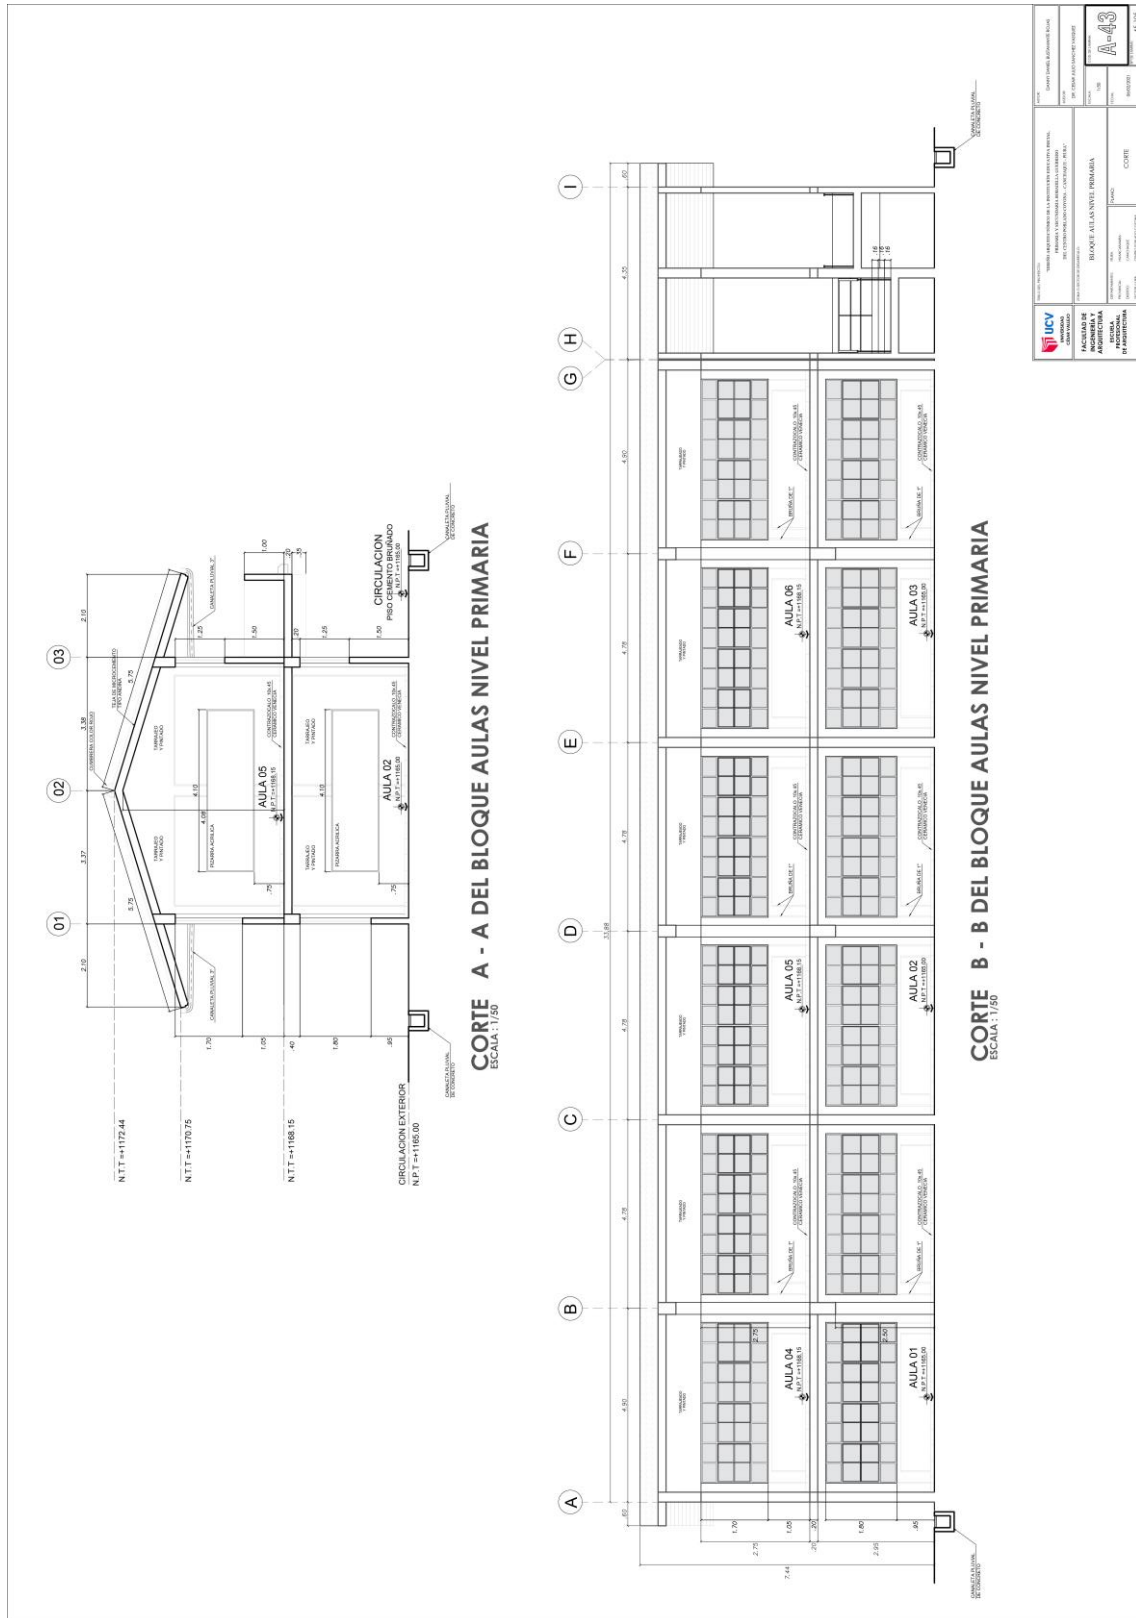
PLANO CORTE GENERAL NIVEL PRIMARIA
